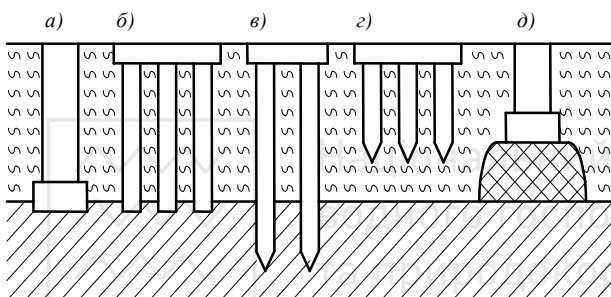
Варіанти влаштування фундаментів при напластунні ґрунтів за схемою II
